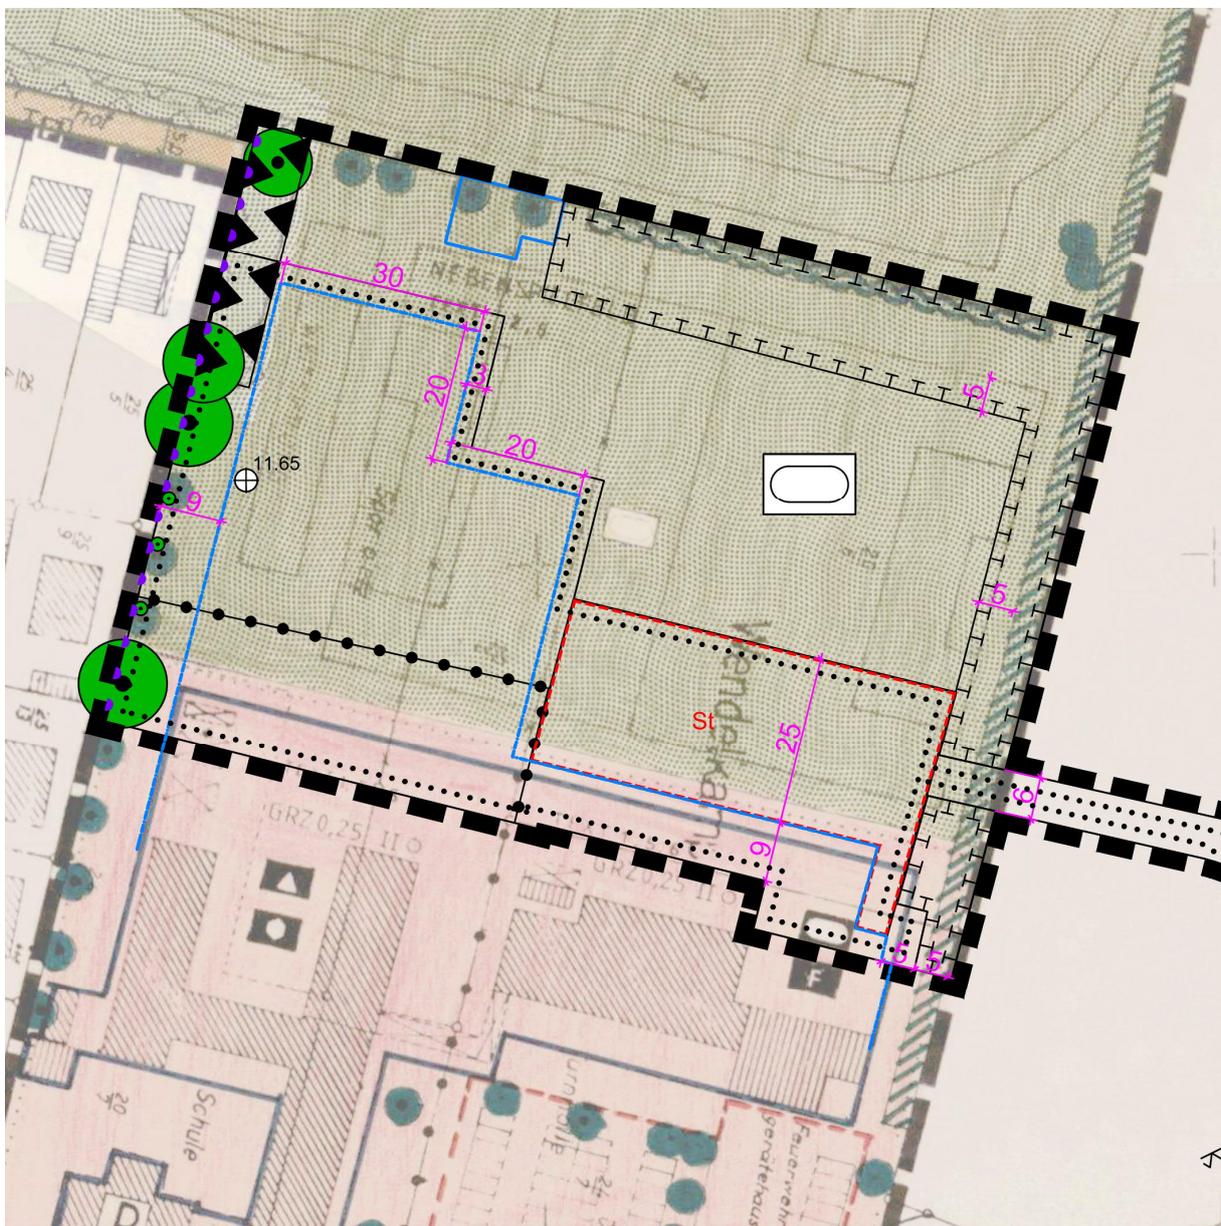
Überschneidung der 1. Änderung mit dem Ursprungs-B-Plan Nr. 7
